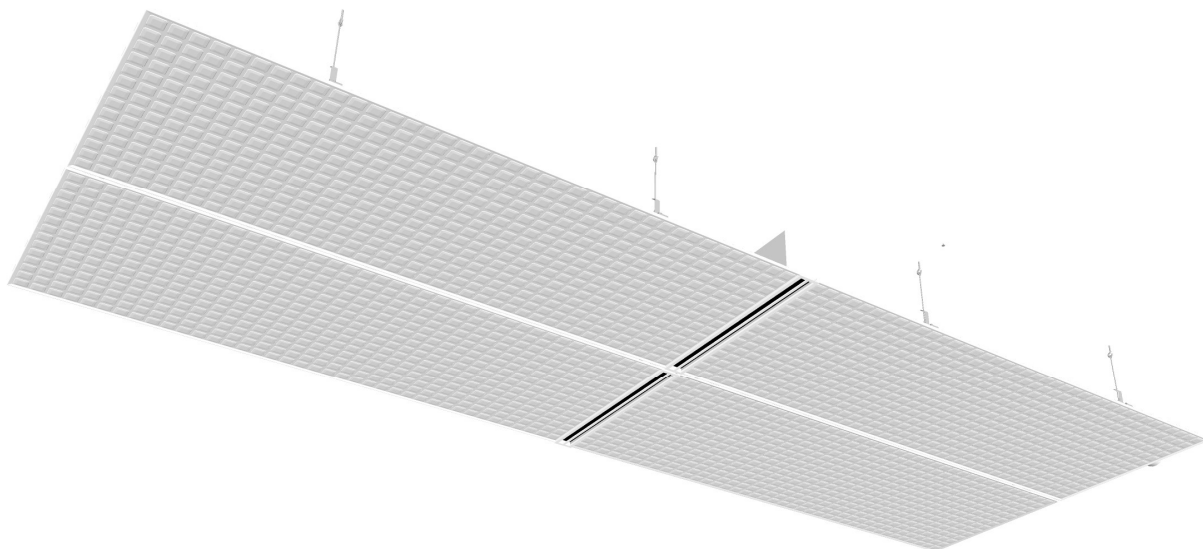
Îlot de 4 panneaux climatiques Kigo standard (avec grille de ventilation optionnelle)
